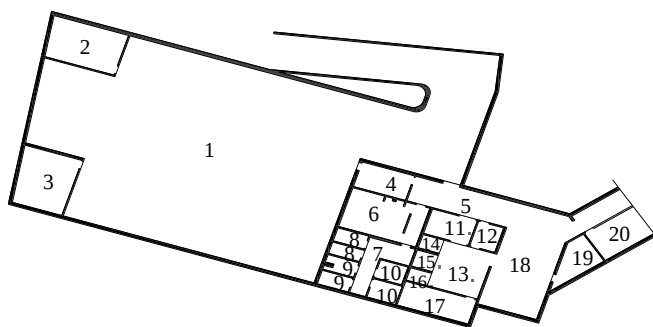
| Planta esquemática do Piso - 1 - Bloco de Internamento.
